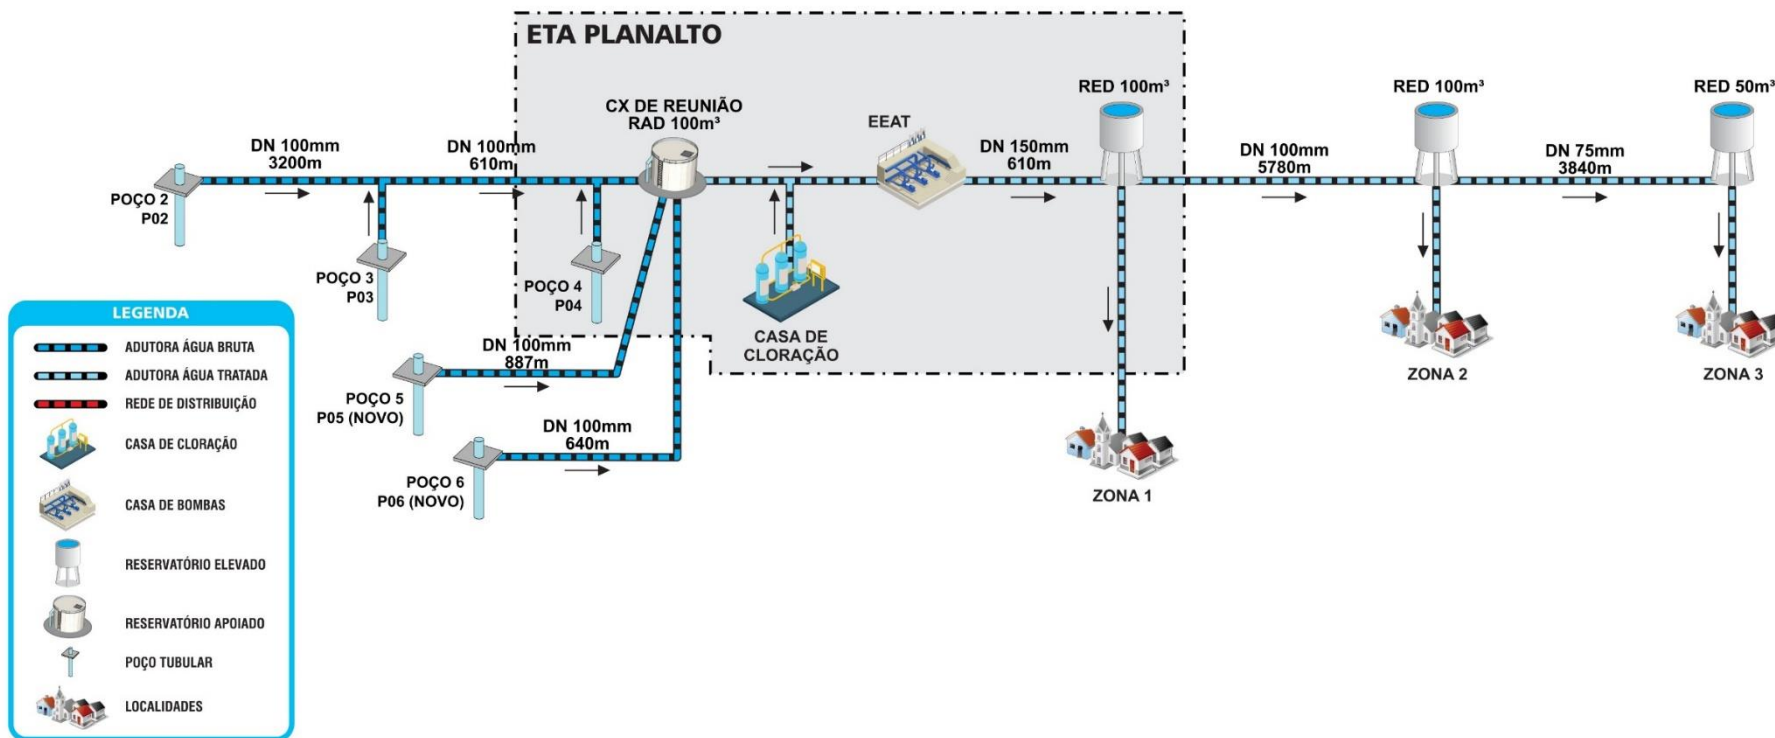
Croqui esquemático com as Intervenções Estruturais Previstas para Ampliação do SAA Planalto
